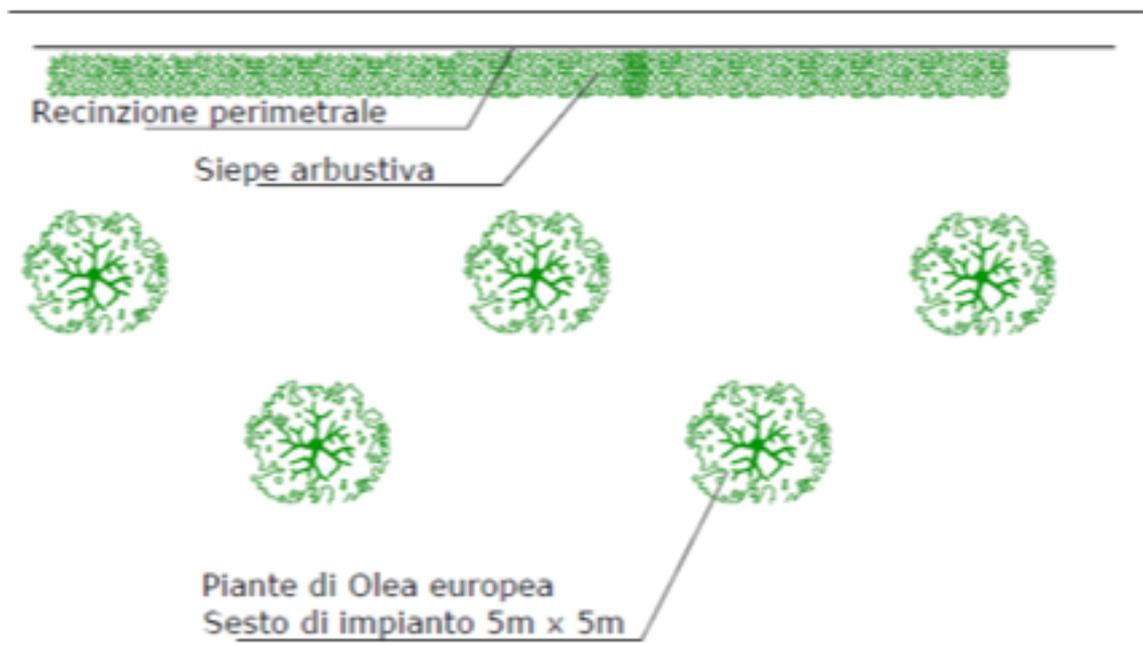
Distribuzione piante di olivo e della siepe nella fascia di mitigazione perimetrale
